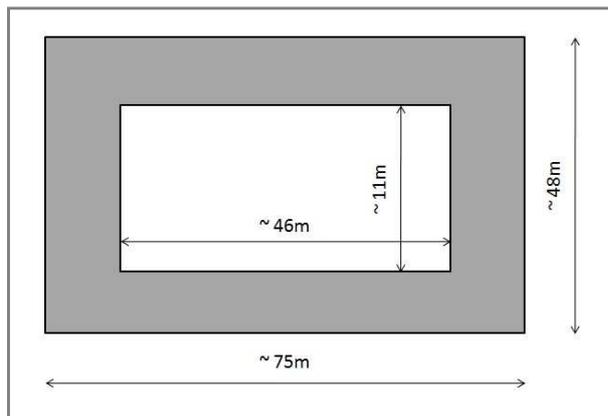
Schematischer Grundriss Bürogebäude¹⁴⁵
